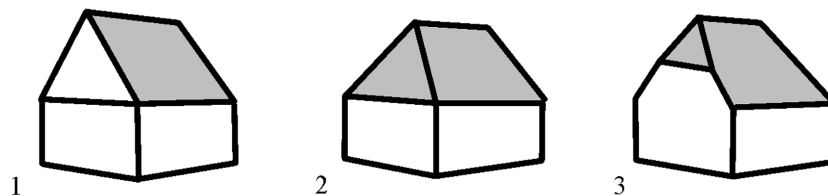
Dachformen. 1: Sattel-, 2: Vollwalm-, 3: Krüppelwalmdach (graue Flächen sind geneigt).
